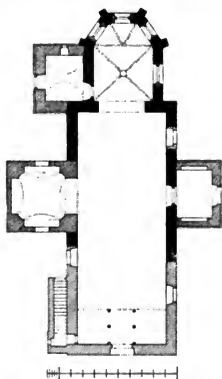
Jilovic, Grundriss der Kirche.
